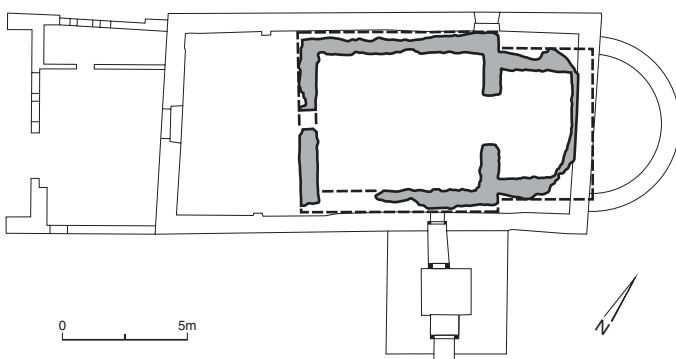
Leissigen. Kirche des 9./10. Jahrhunderts. Rekonstruierter Grundriss. M 1:300.
